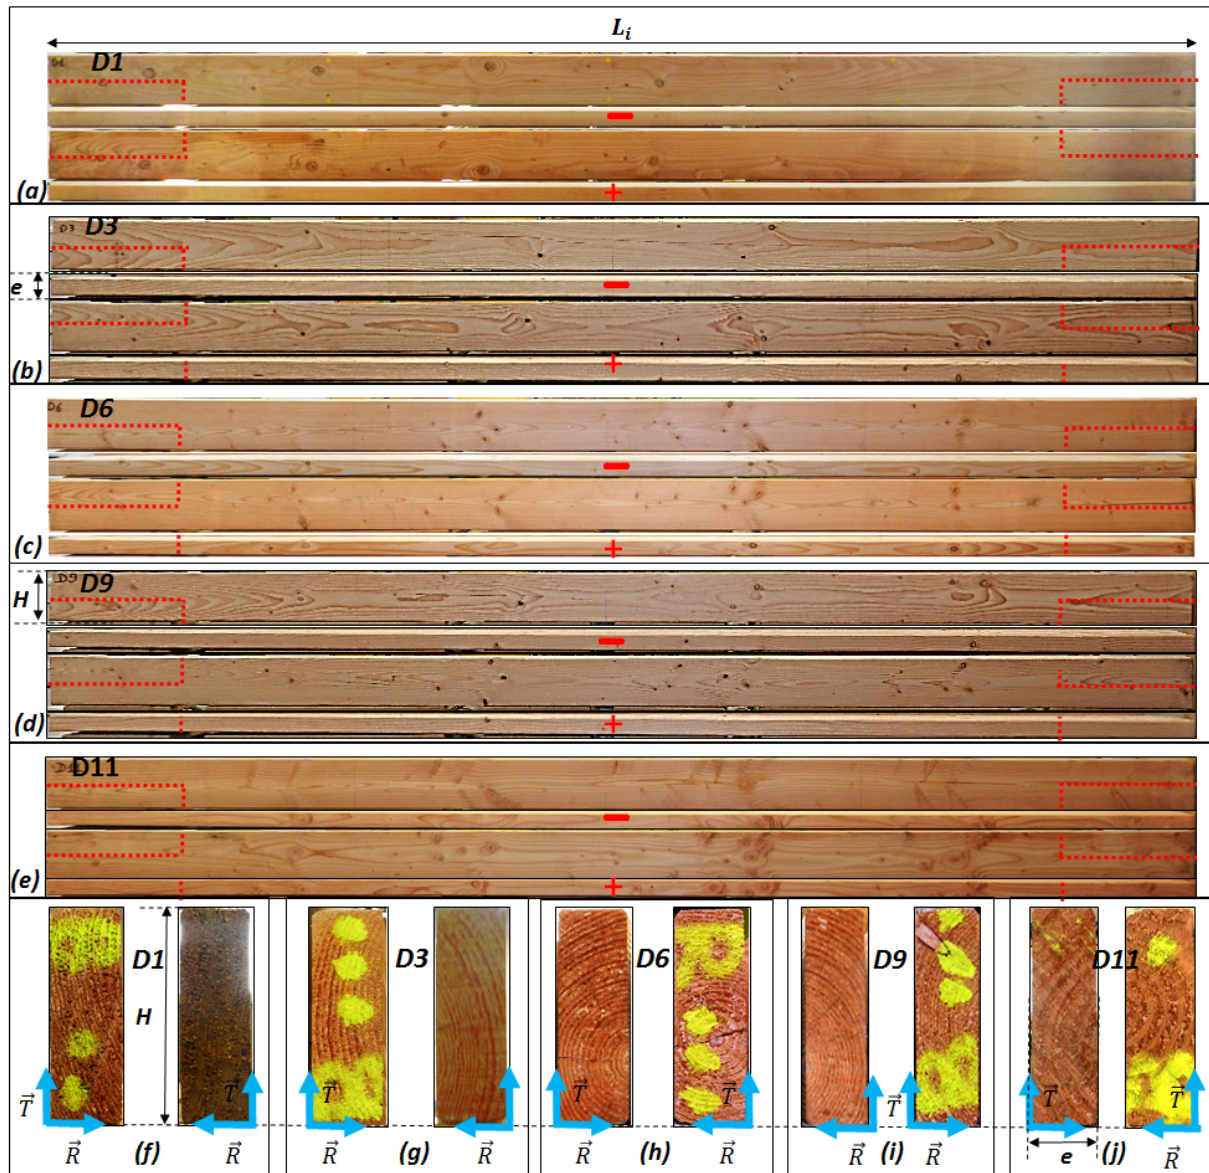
Surfaces externes des poutres de Douglas ( $D$ ) utilisées : (a,f) poutre  $D1$  ; (b,g) poutre  $D3$  ; (c,h) poutre  $D6$  ; (d,i) poutre  $D9$  ; (e,j) poutre  $D11$ . Pour la légende voir Fig. 2.1.
